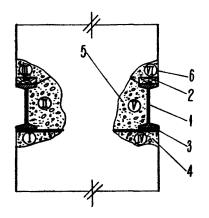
Схема установки обвязочных балок: 1-обвязочная балка; 2-распределительная доска; 3-лента из двух слоев руберойда; 4-выравнивающий слой бетона; 5-бетон; 8-раствор. (Римскими цифрами показан порядок работ по заделке пазух между обвязочными балками и кладкой стены)
